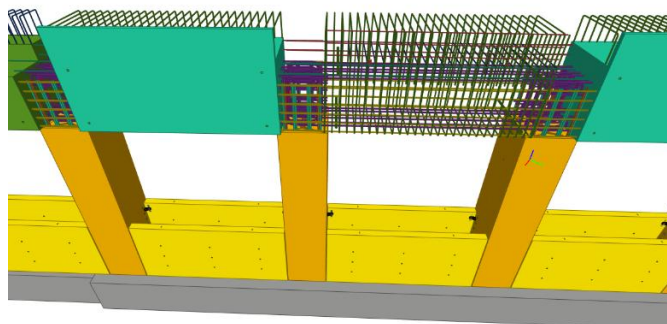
Vista 3D del modelado de la armadura de un dintel prefabricado
